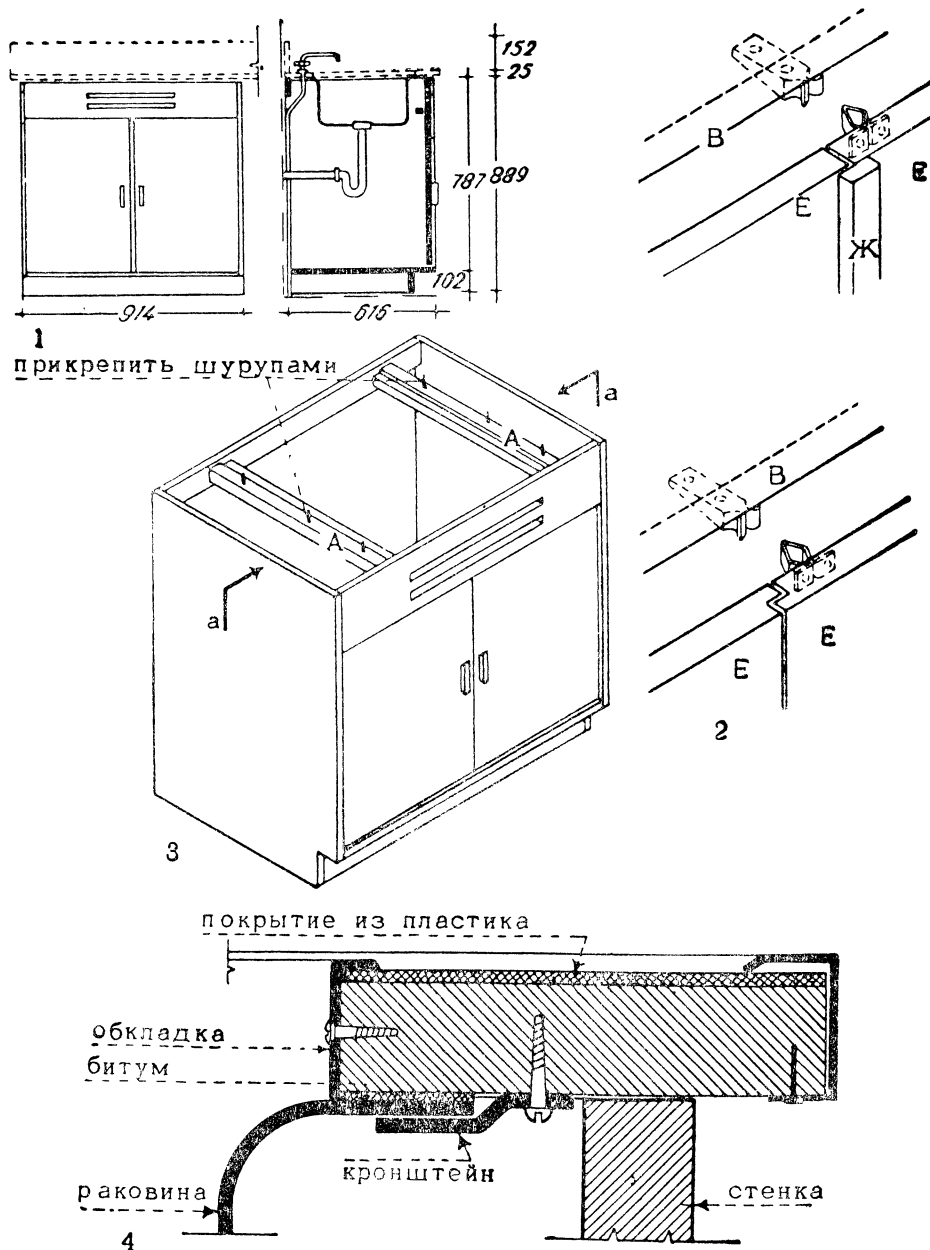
4. 1 — вид спереди и разрез, 2 — установки защелок в дверках; 3 — крепление раковины деревянными брусками на шурупах; 4 — детали крышки и крепления раковины металлическими зажимами.
